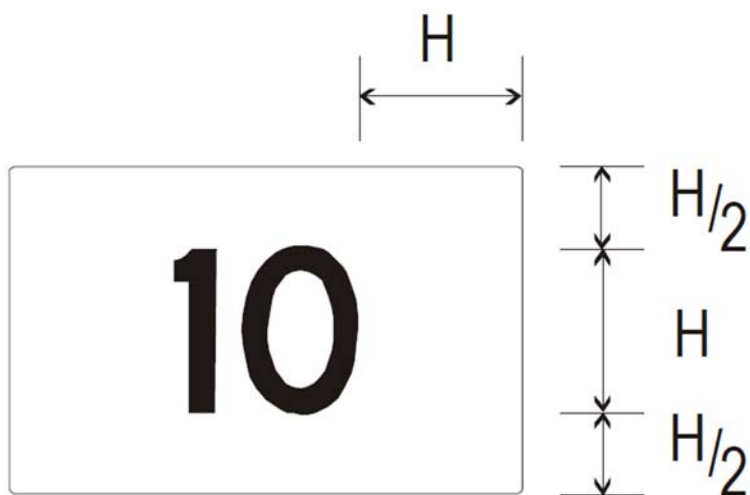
Dimensions d'un panneau à un indicatif de piste
